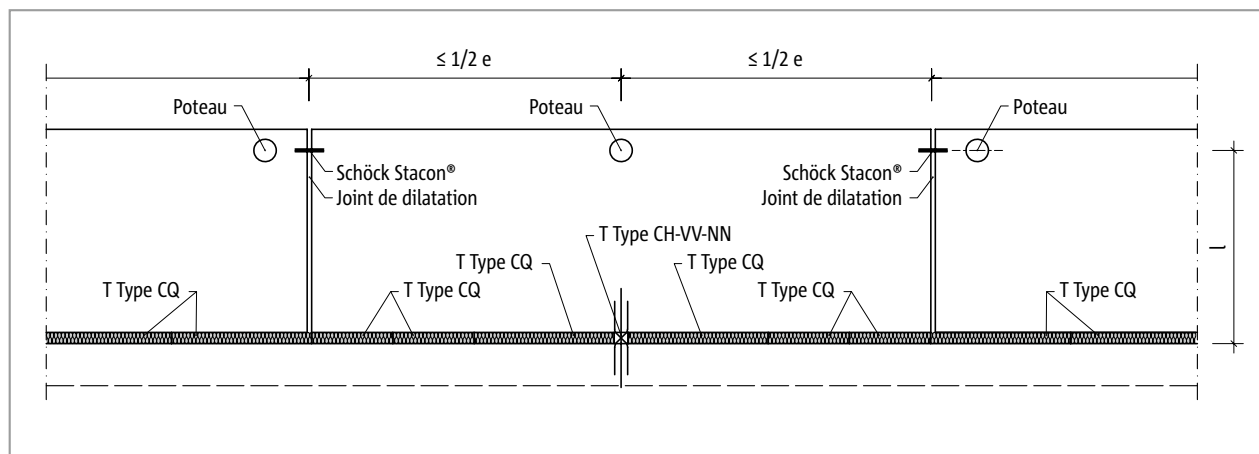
Schöck Isokorb® T Type CH : disposition du joint de dilatation
